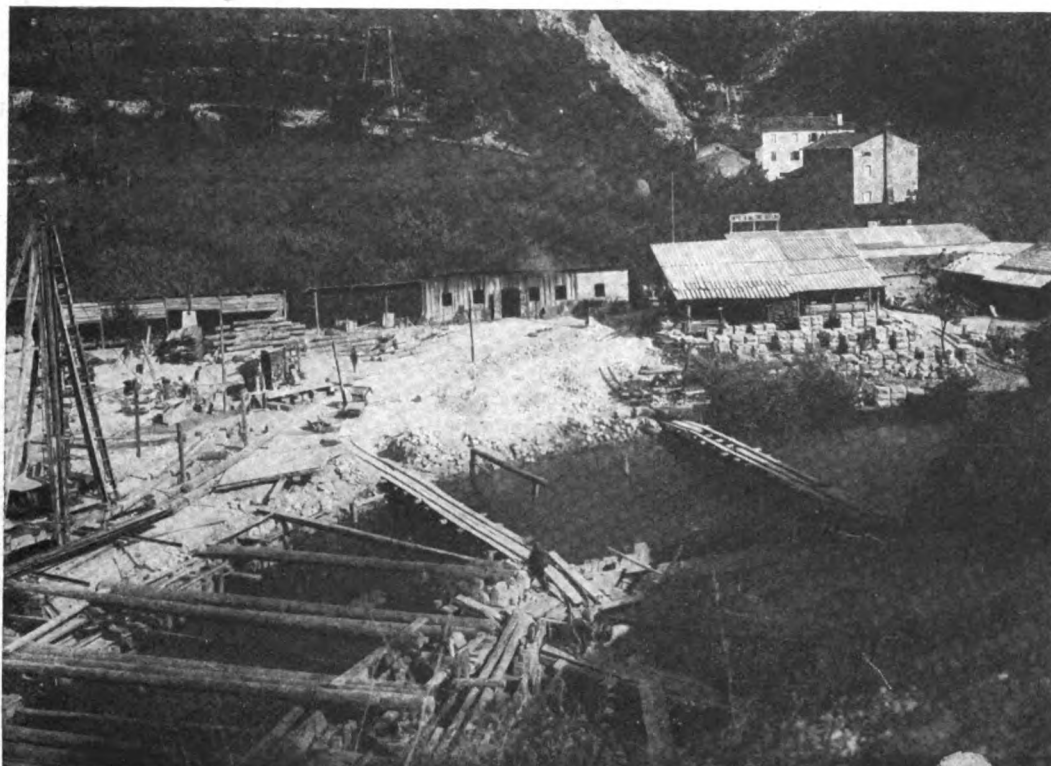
Viadotto Meschio. Veduta de cantiere.
